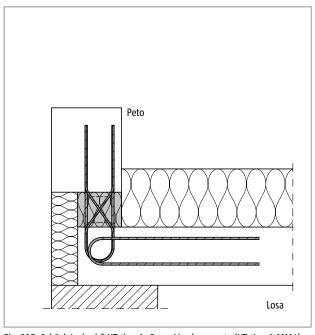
Schöck Isokorb® XT tipo A: Conexión de un peto (XT tipo A-MM1)
